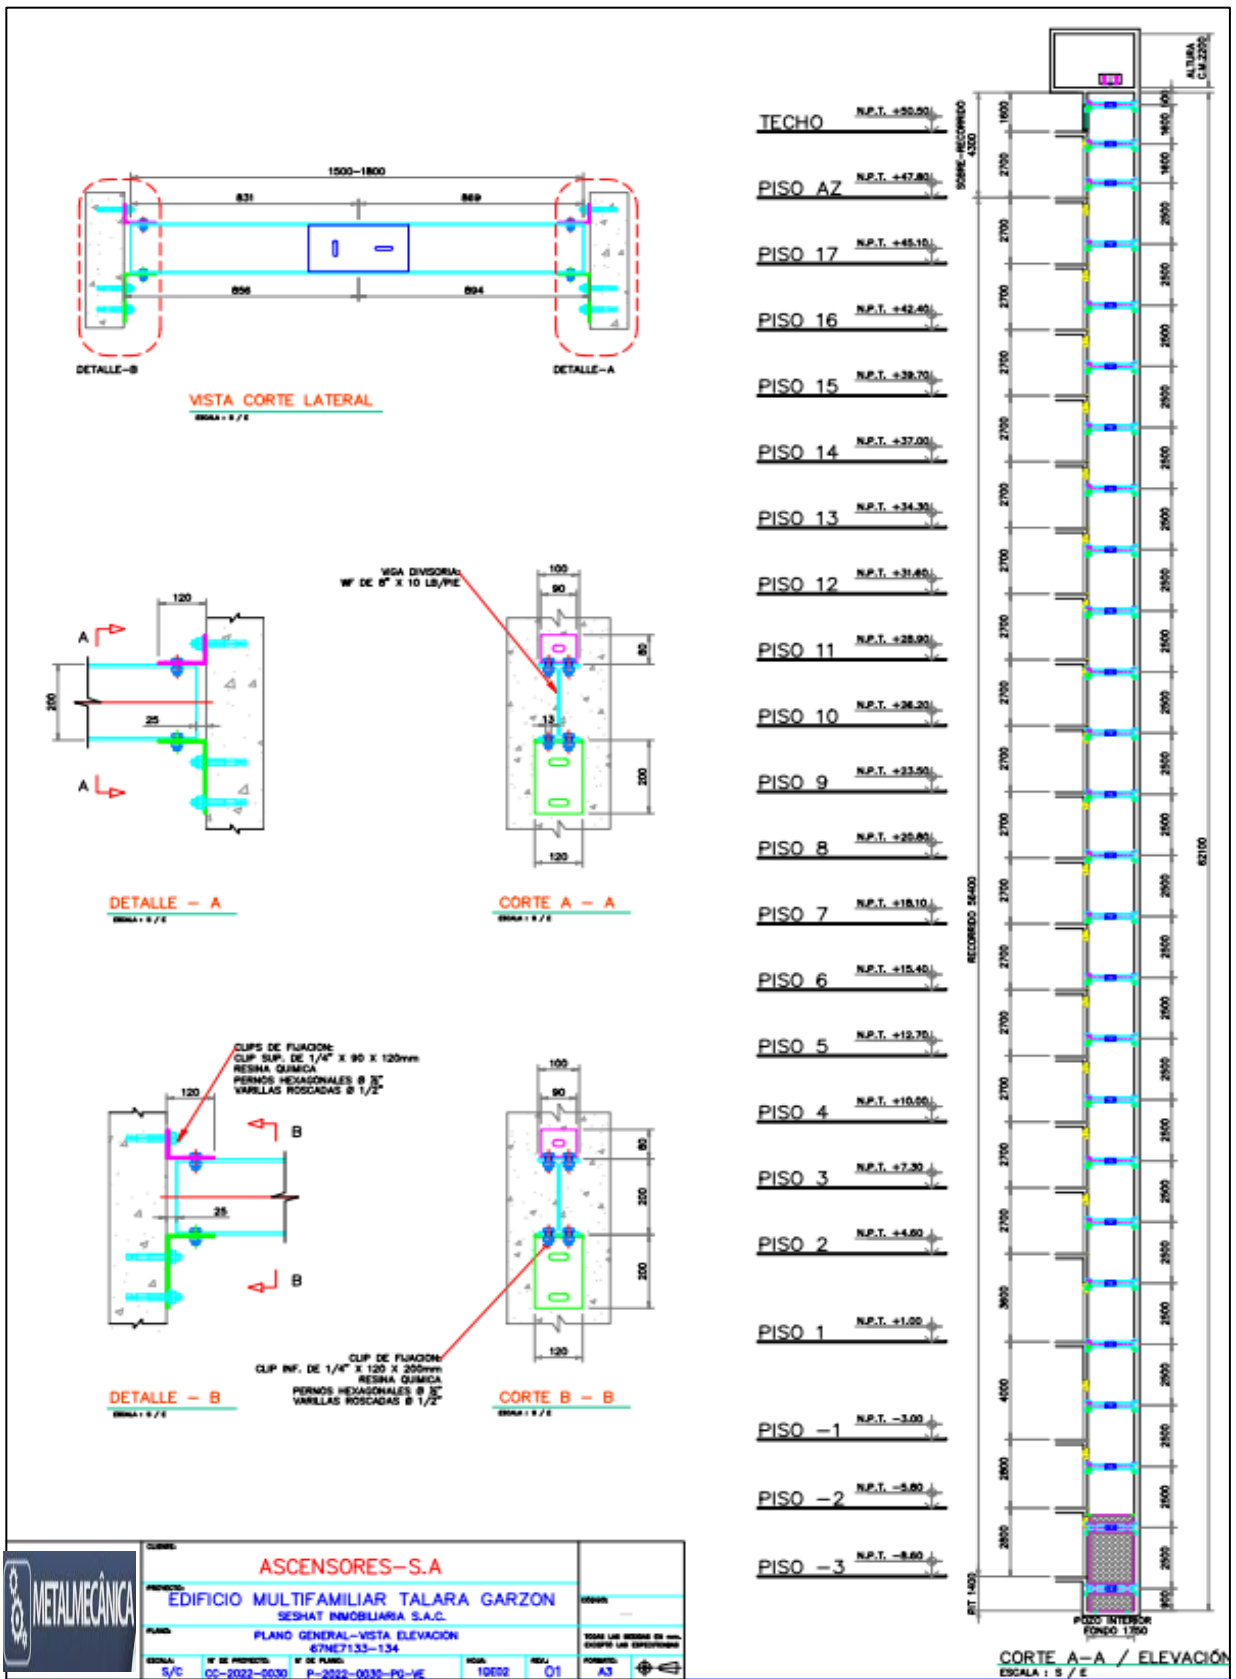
Vista lateral del plano de montaje de vigas divisoras
